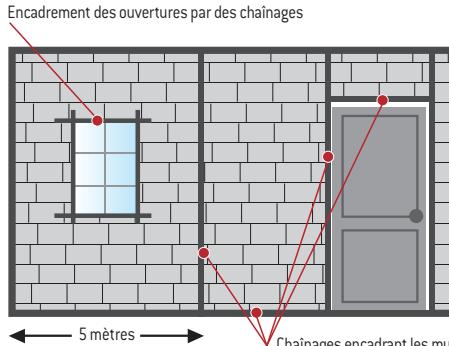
Ajout de chainages horizontaux et verticaux encadrant les maçonneries (élévation)
